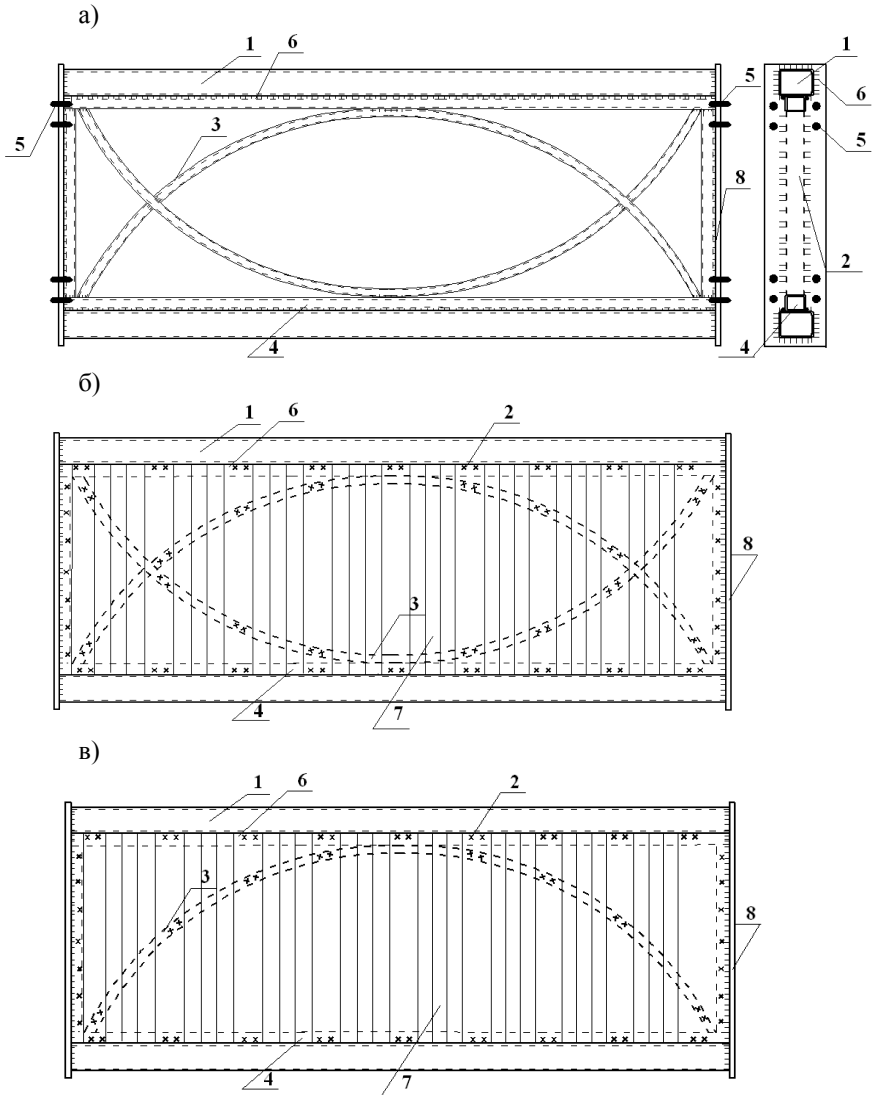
Сталева балка з подвійною поперечно профільованою стінкою з решіткою у вигляді арочних елементів: а – вихідна заготовка з подвійними арочними елементами; б – готовий відсік з подвійними арочними елементами; в – готовий відсік з одиночним арочним елементом
